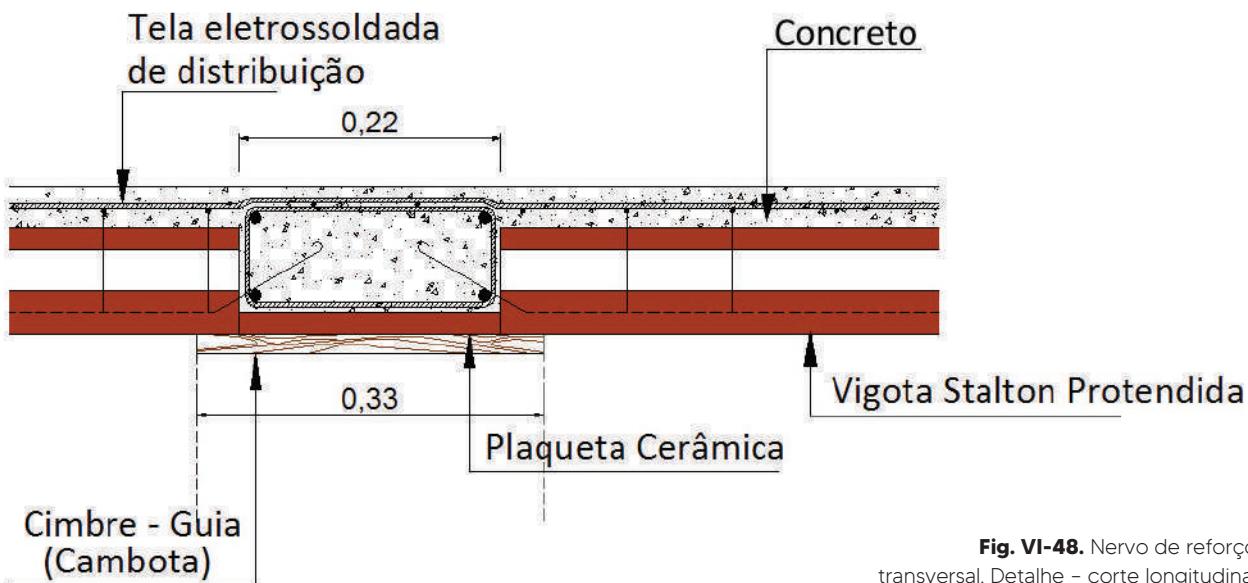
Nervo de reforço transversal. Detalhe – corte longitudinal da abóboda na união e continuidade de vigotas sobre a cambota. (*-5).
